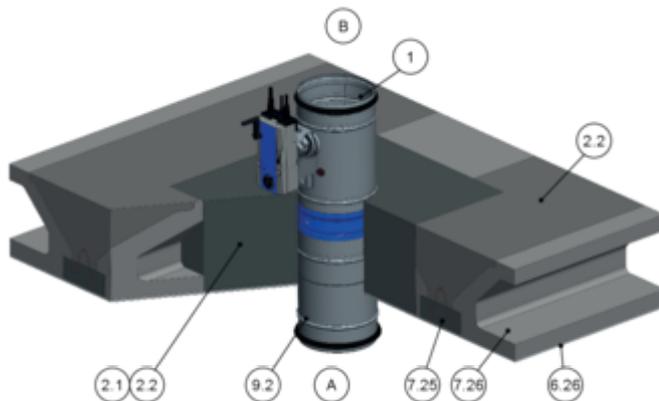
Nasseinbau in Massivdecke mit Betonsockel stehend, Mehrfachbelegung
